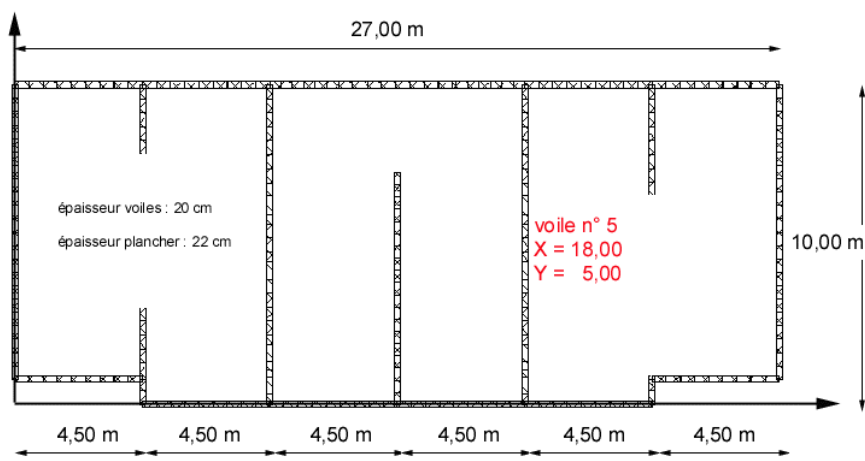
Vue en plan d'un bâtiment diagnostiqué
